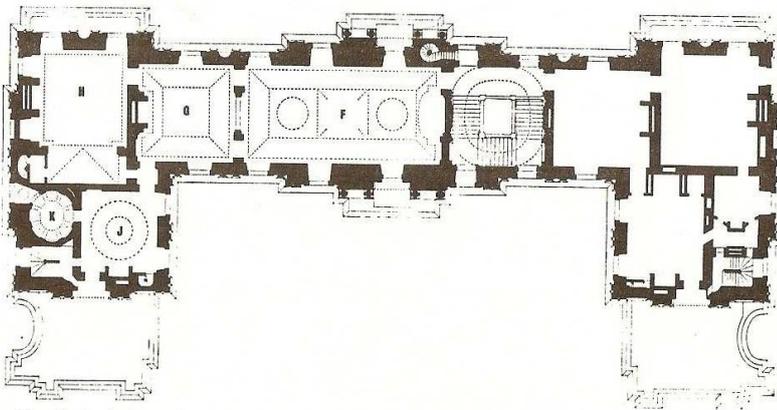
Maisons-Laffitte, Grundriss Obergeschoss
